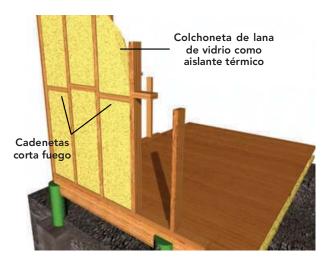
24: Tabique perimetral con aislante térmico tipo lana de vidrio.
